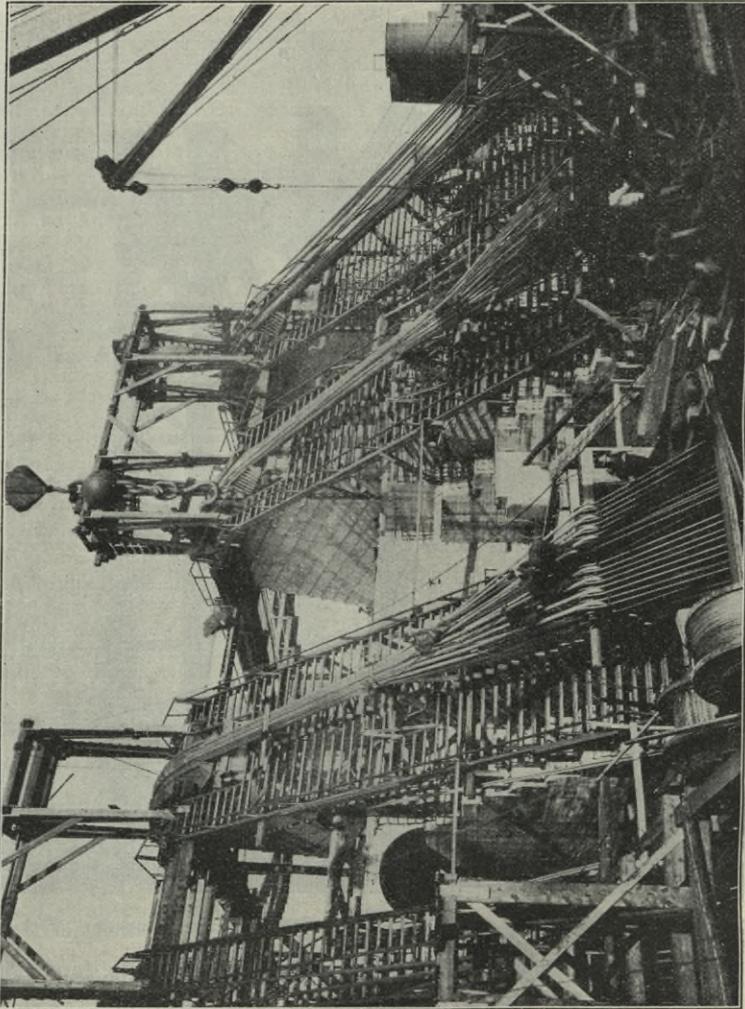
Manhattan-Brücke in New York. Befestigung der Kabel an den Verankerungen.
